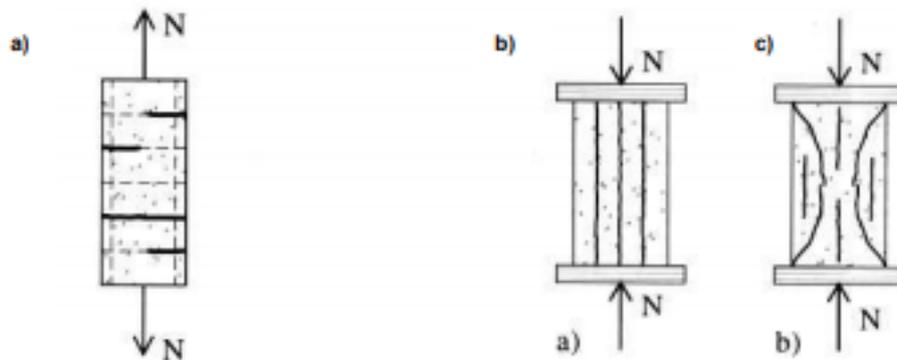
Representação esquemática da fissuração devido ao esforço de tração e compressão. Fonte: Cánovas, 1988.
